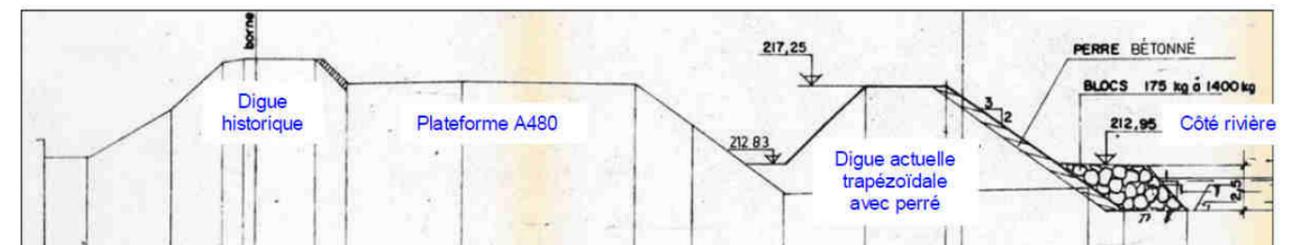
Profil en travers niveau Projet de la construction de l'A480
